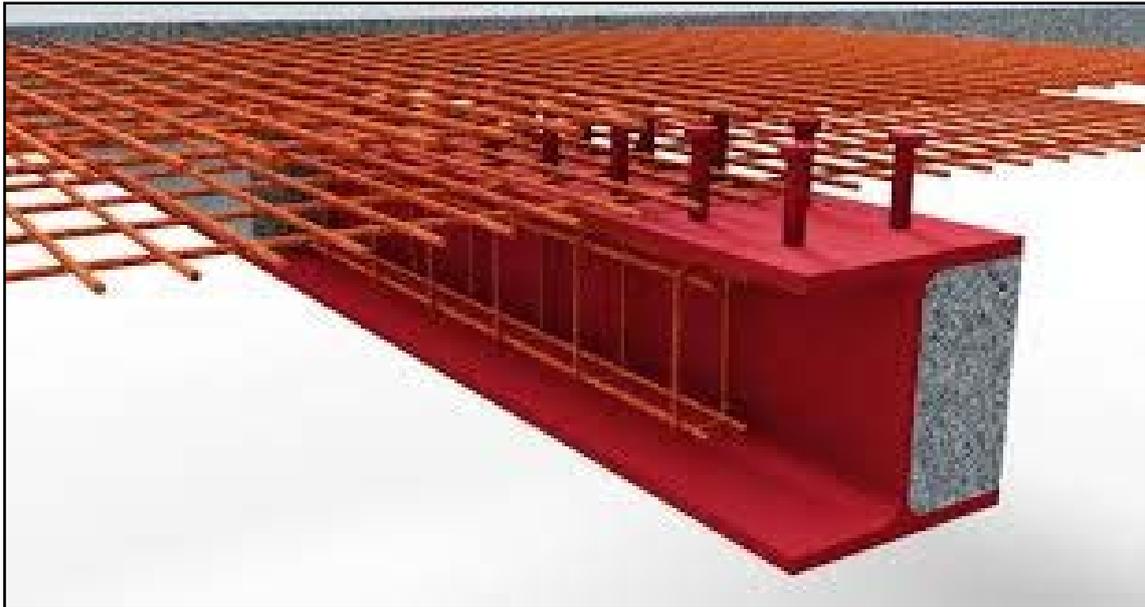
exemple d'une poutre mixte partiellement enrobée.
